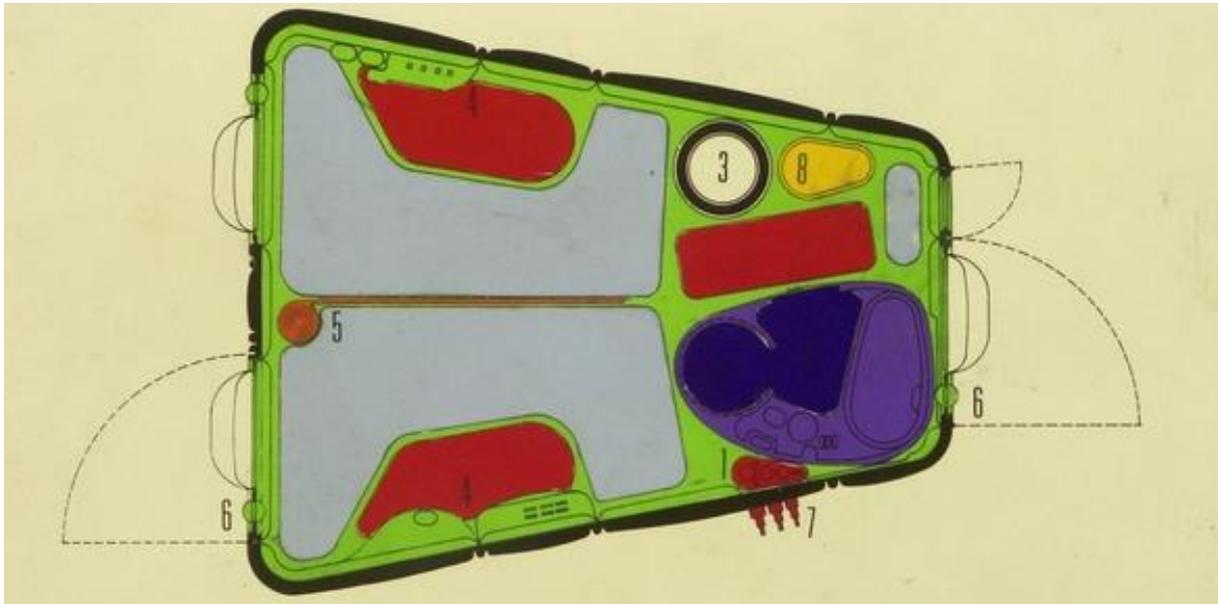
| Planta da cápsula de Warren Chalk. 1- Condutas; 2- Casa de banho; 3- Elevador hidráulico; 4- Dispositivo anexo à parede; 5- Tela de separação; 6- Porta principal; 7- Conexões de serviço; 8- Pequena zona de armazenamento (Šenk, 2013). (Fonte: Archigram Archival Project).
